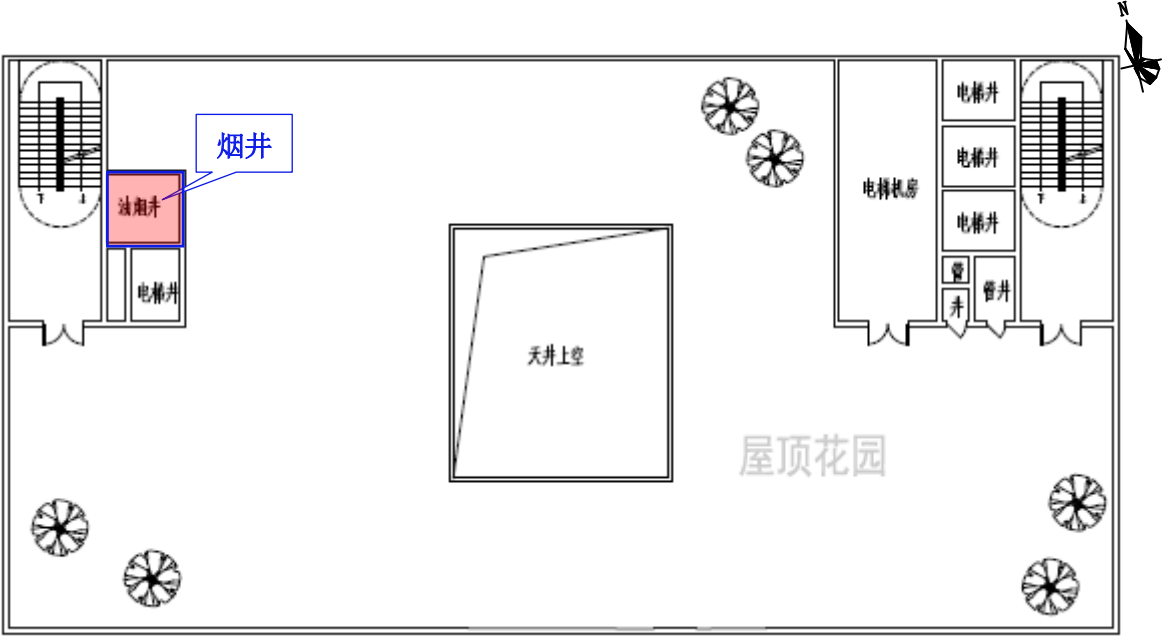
项目医疗综合楼裙楼—行政科研楼屋顶层平面布置图（比例尺：1:297）
